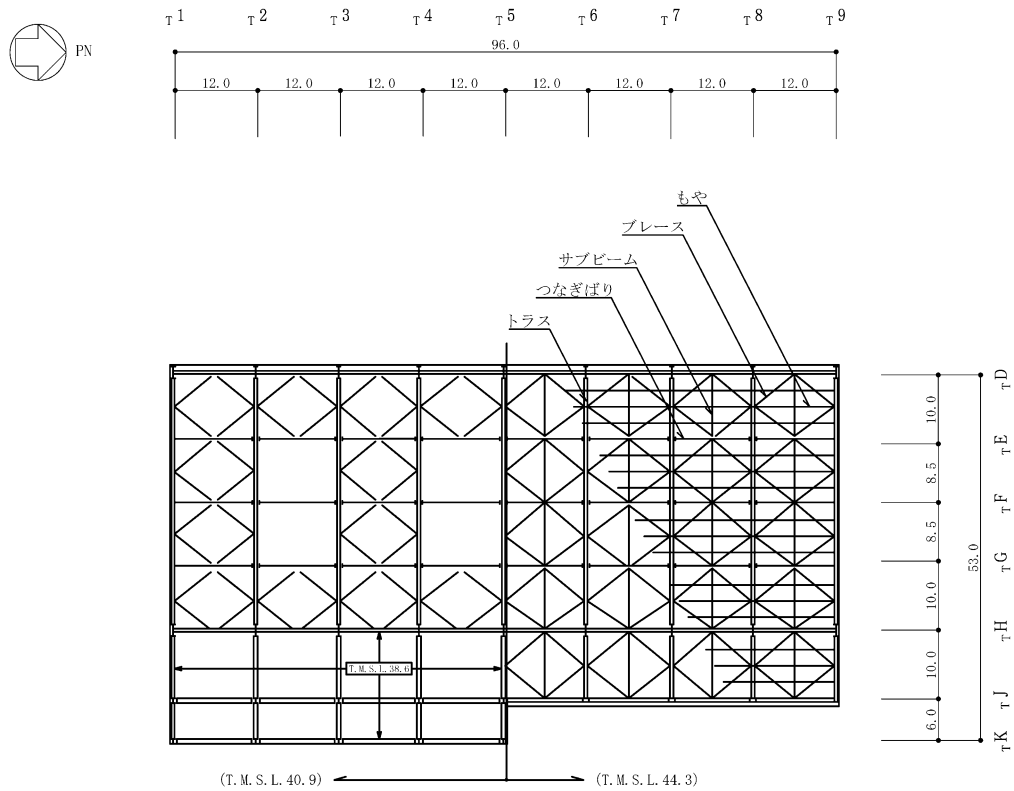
タービン建屋の概略平面図 (RF, T.M.S.L. 44.3m) (6/6) (単位 : m)
